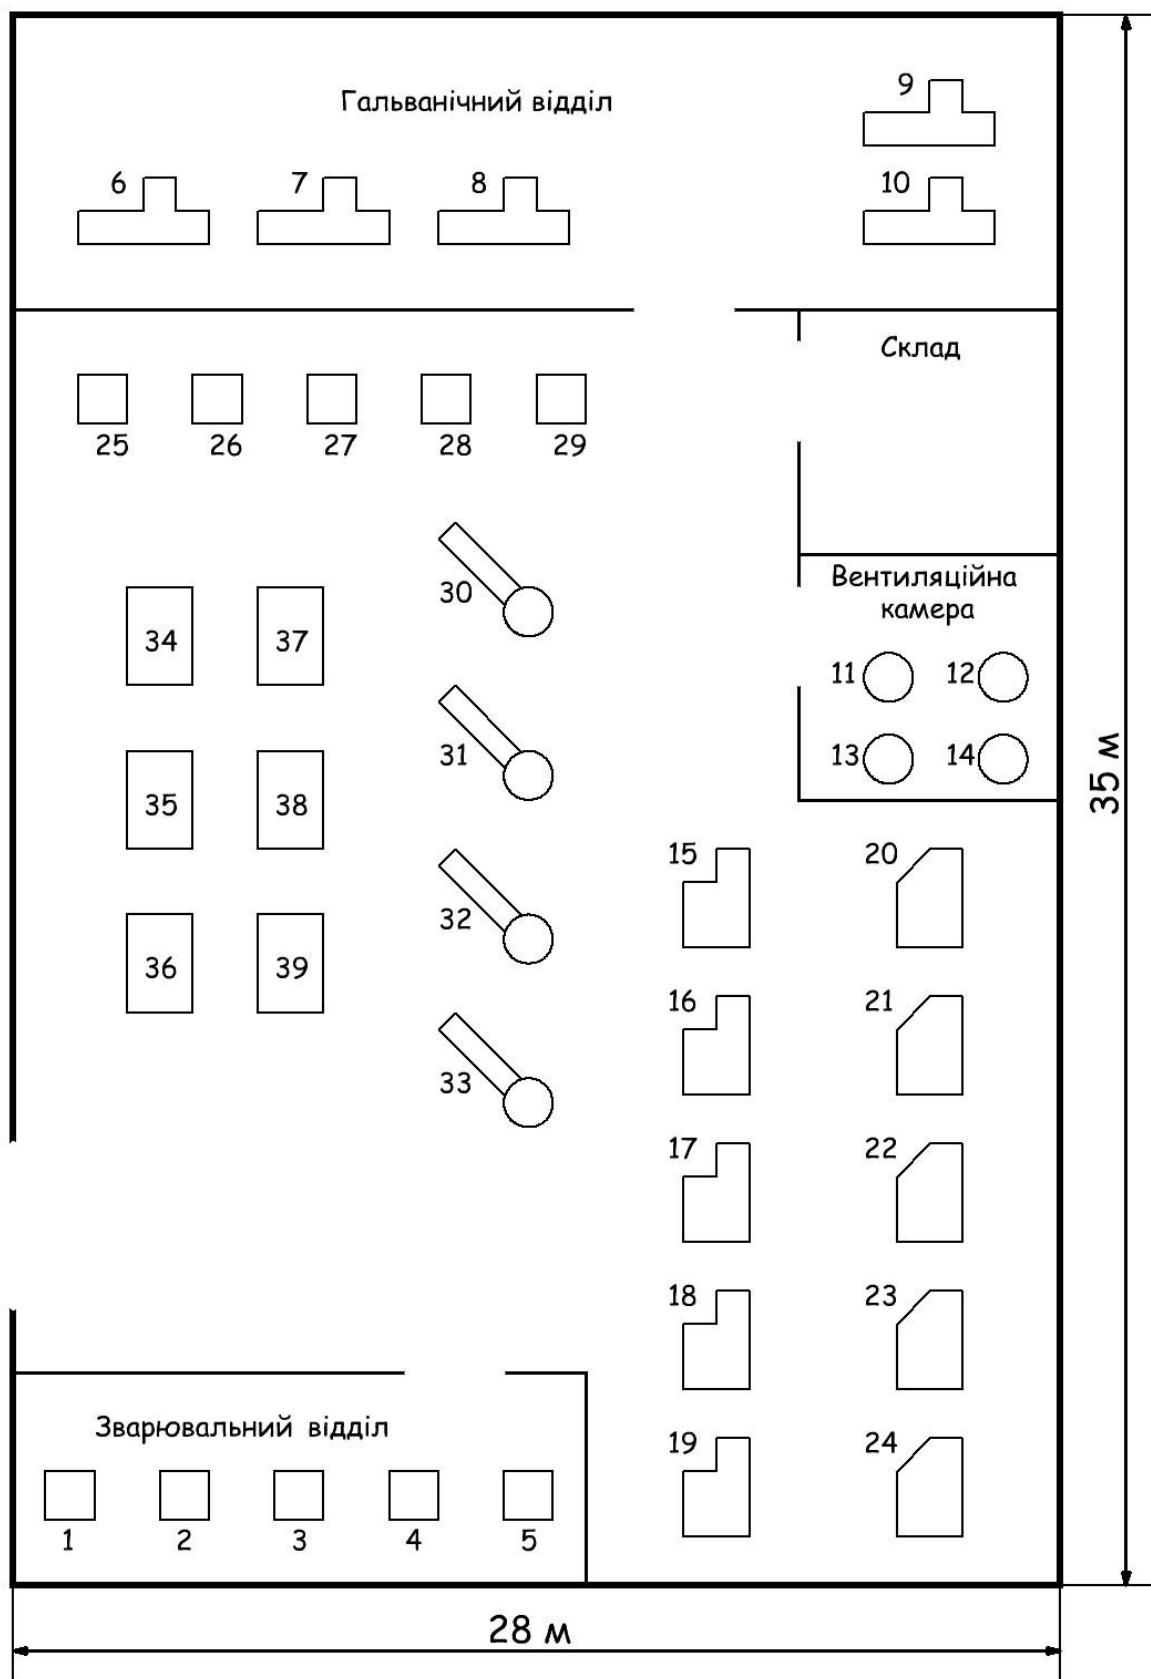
План розміщення ЕП цеху обробки корпусних деталей
